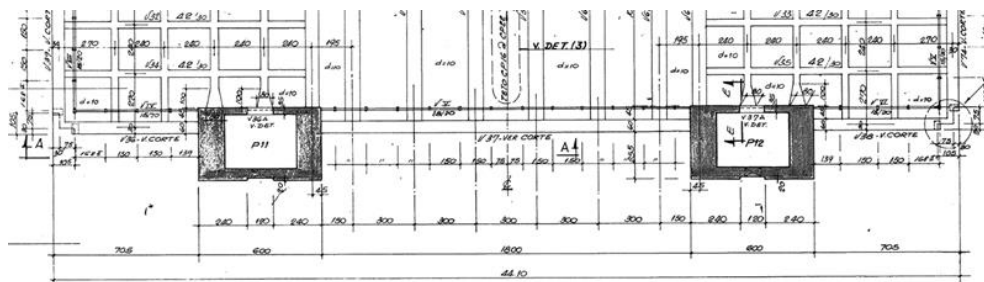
Torre Rio Sul. Trecho da planta de Fôrmas do Teto Tipo, trecho periférico ao núcleo.
